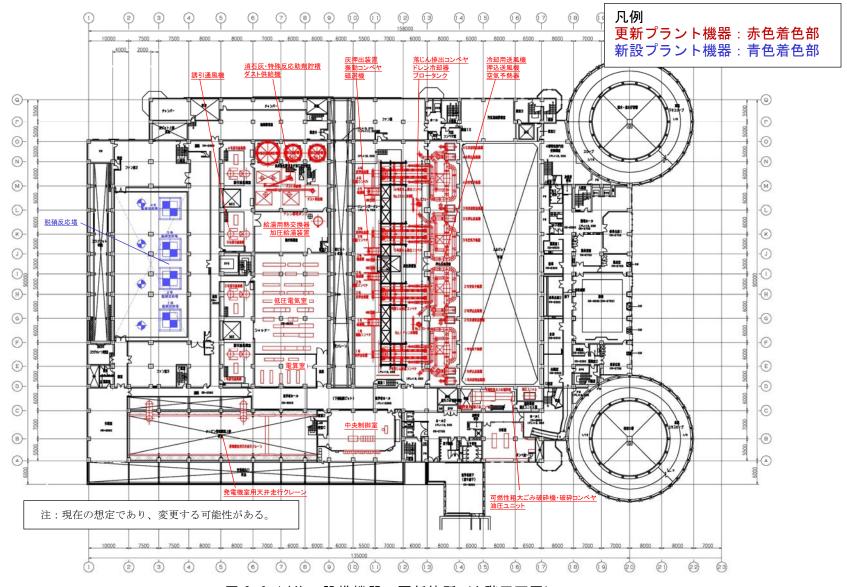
(4) 設備機器の更新箇所(4階平面図)
